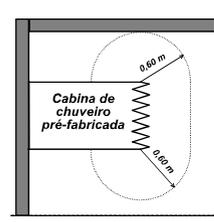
C — Cabina de chuveiro pré-fabricada (sem escala)
